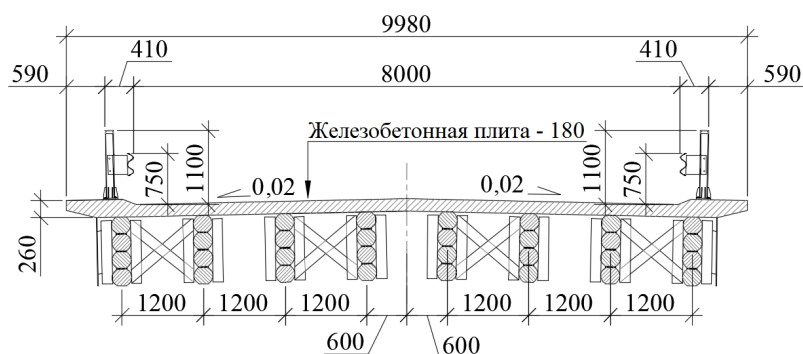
Поперечное сечение пролетного строения моста, длиной 15 м с составными прогонами из бревен и монолитной железобетонной плитой, через р. Нягов
